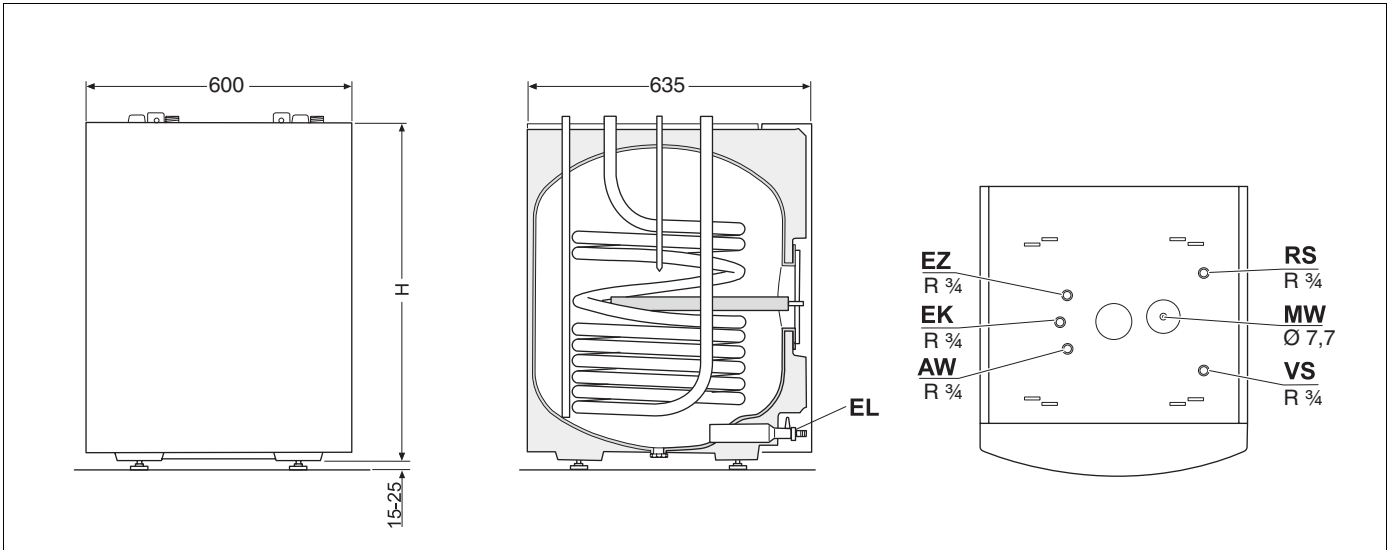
Abmessungen und Anschlüsse (Maße in mm)
